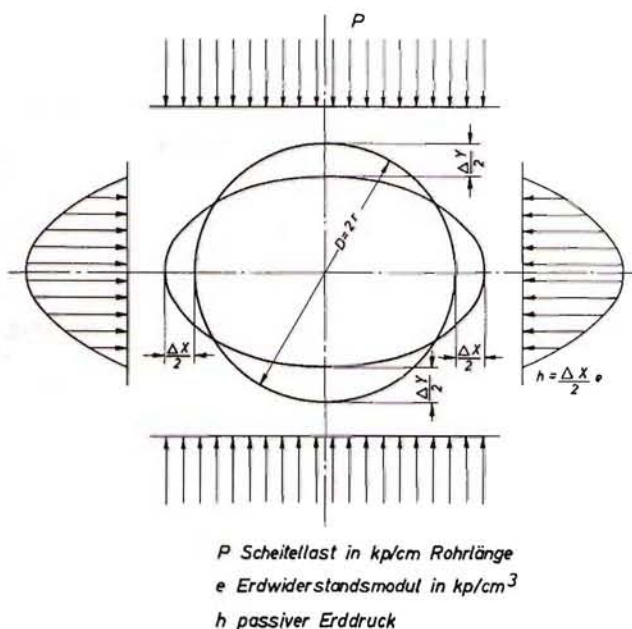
Grundlagen für die Ableitung der Iowa-Formel nach M. G. Spangler [6]
